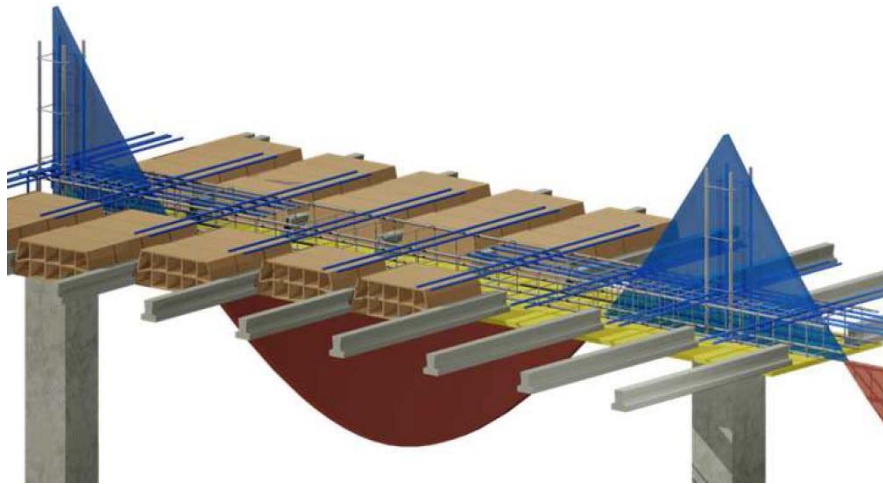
Momentos en viga in situ - Apuntes estructuras 2 (UPV)
